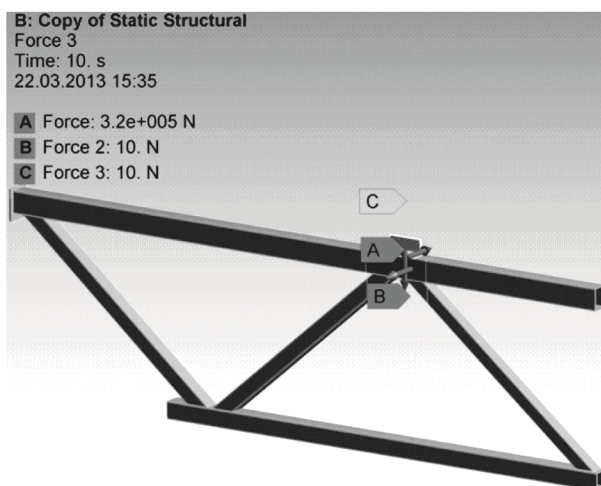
Расчетная модель подстропильной фермы ПФ-12-30
